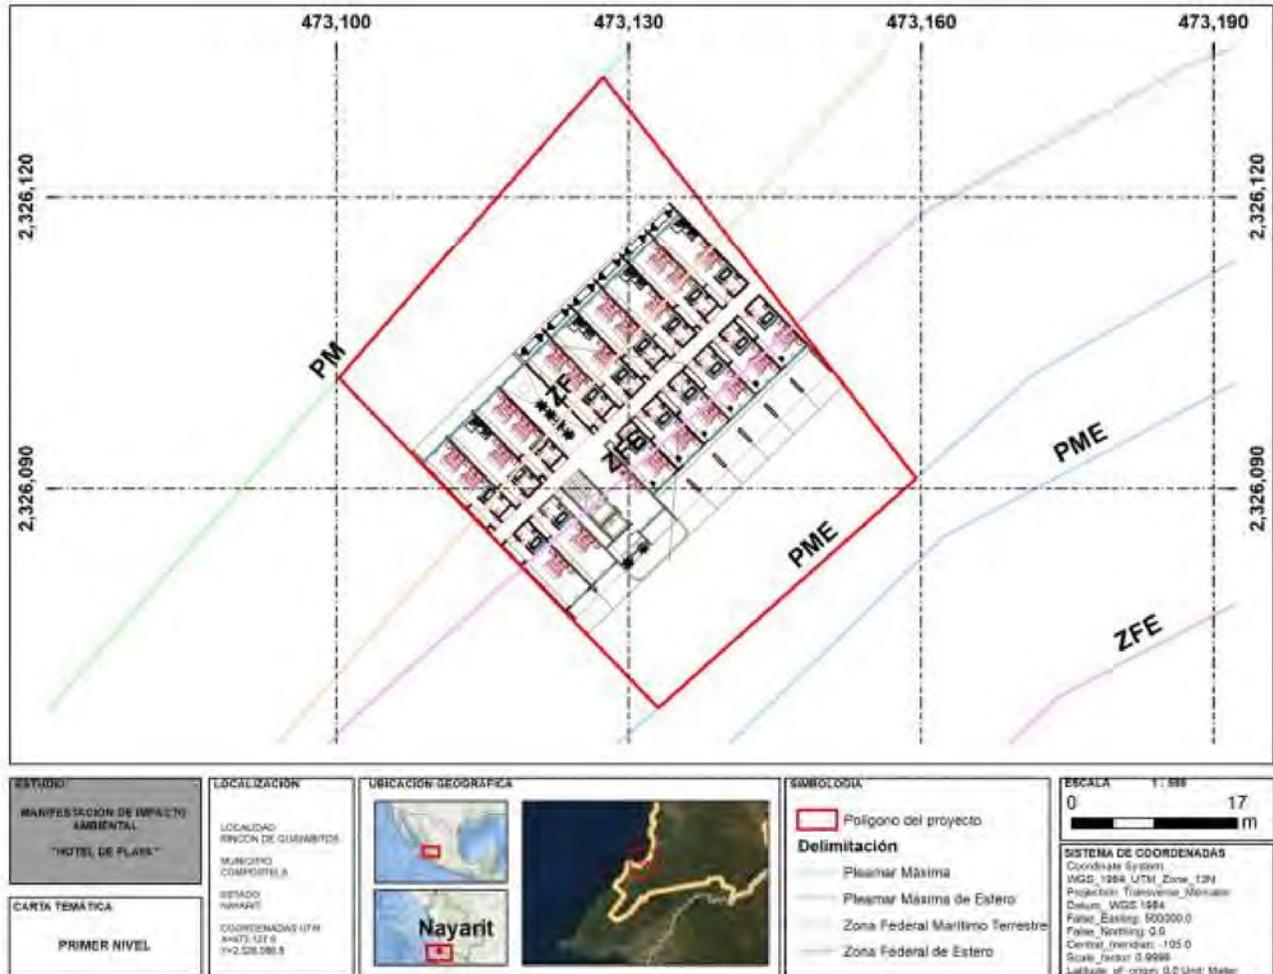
Modelo de diseño estructural de la planta primer nivel del proyecto.
